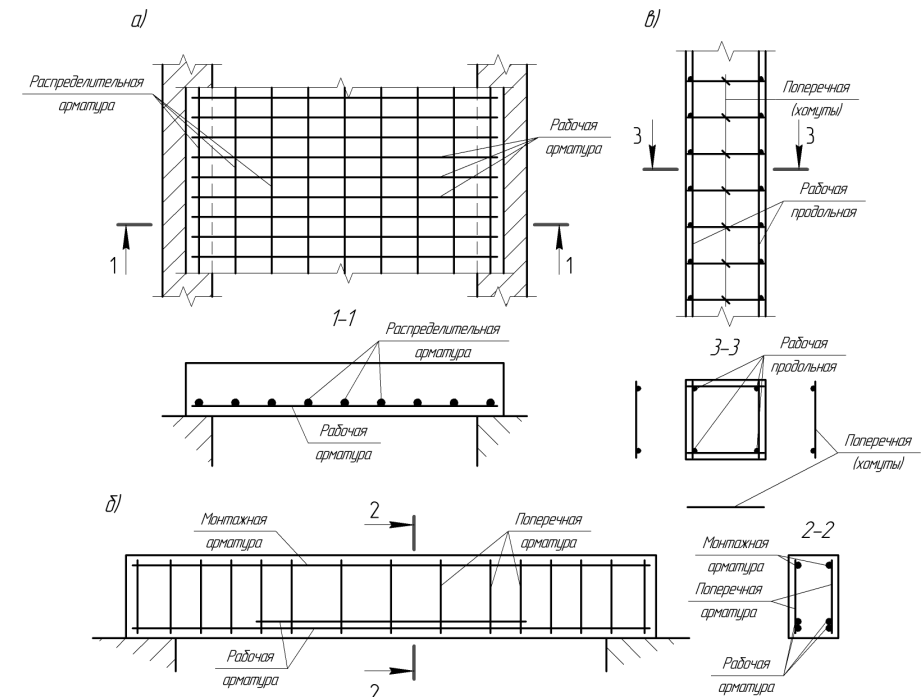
Армирование ж/б элементов: а – плиты; б – балки; в – колонны
